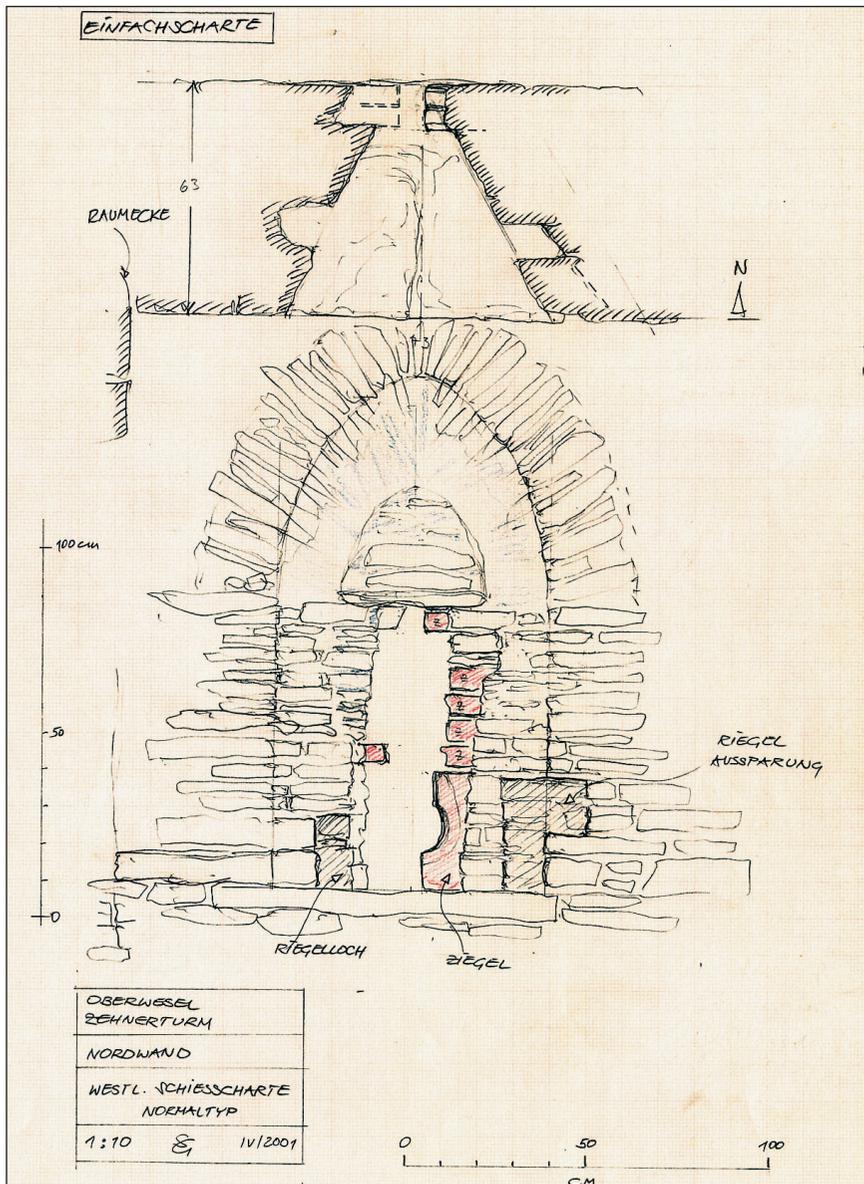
Details einer einfachen Schlüsselochscharte in der Nordmauer, Grundriss und Innenansicht (Handaufmaß: Verf.).
